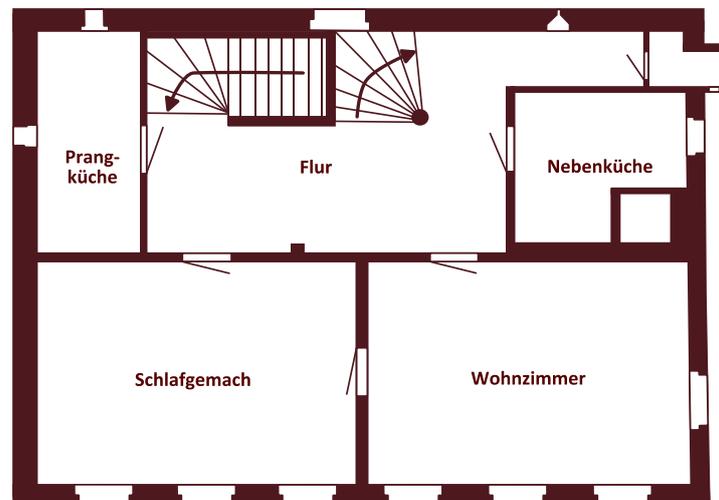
Grundriss 1. Obergeschoß
